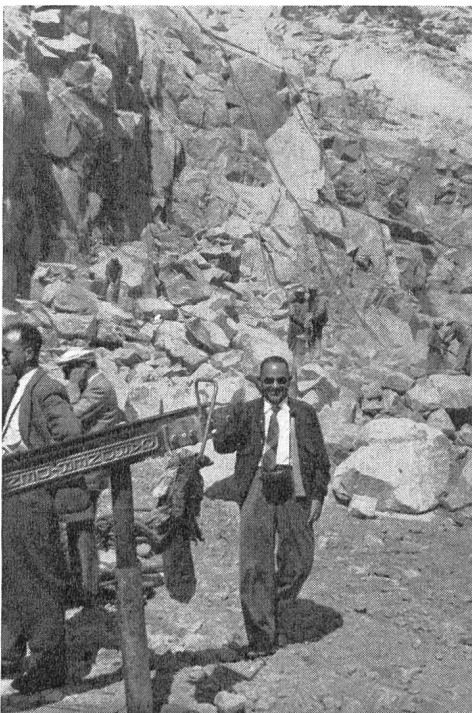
Steinbruchbetrieb auf der Baustelle Malga Bissina (Photo G. A. Töndury)
